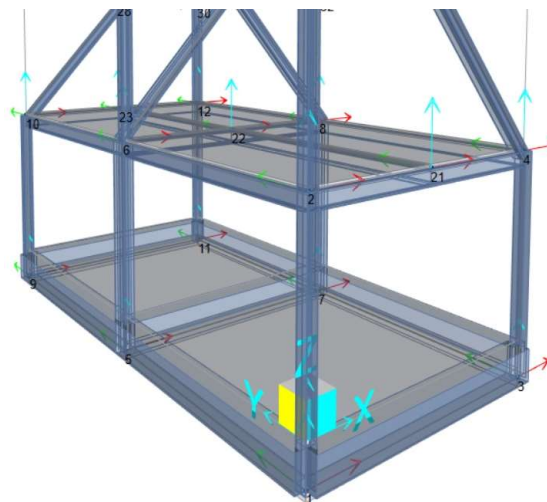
vista del modello FEM della struttura di elevato e delle fondazioni
